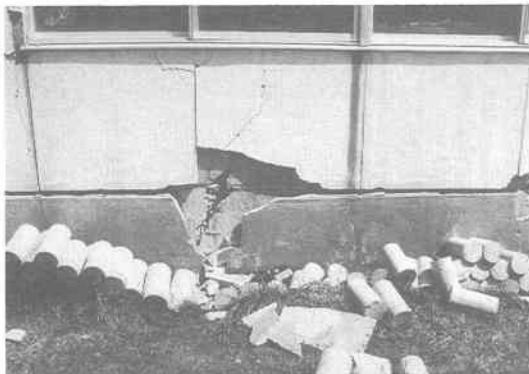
青苗小学校校舎（基礎梁に著しいひび割れ）
